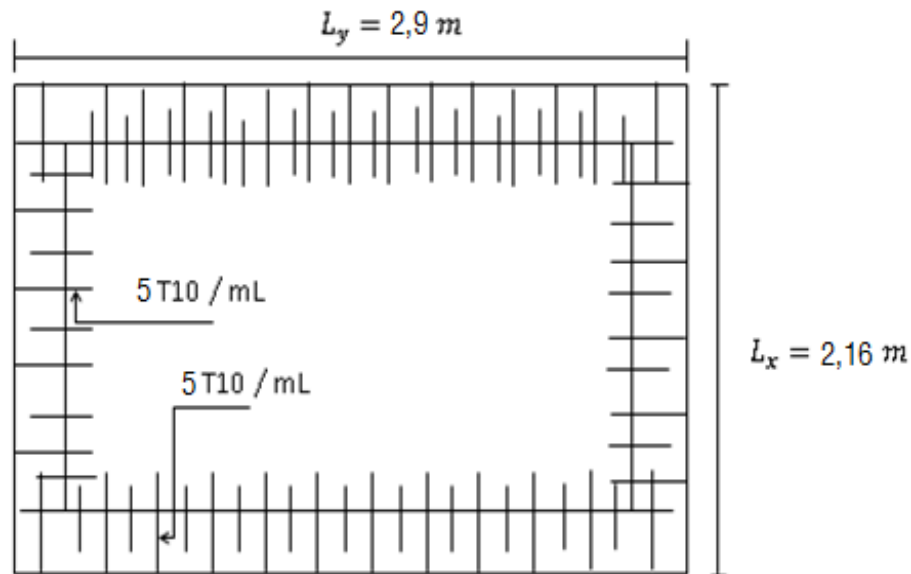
Ferrailage supérieur de la dalle de l'ascenseur.
